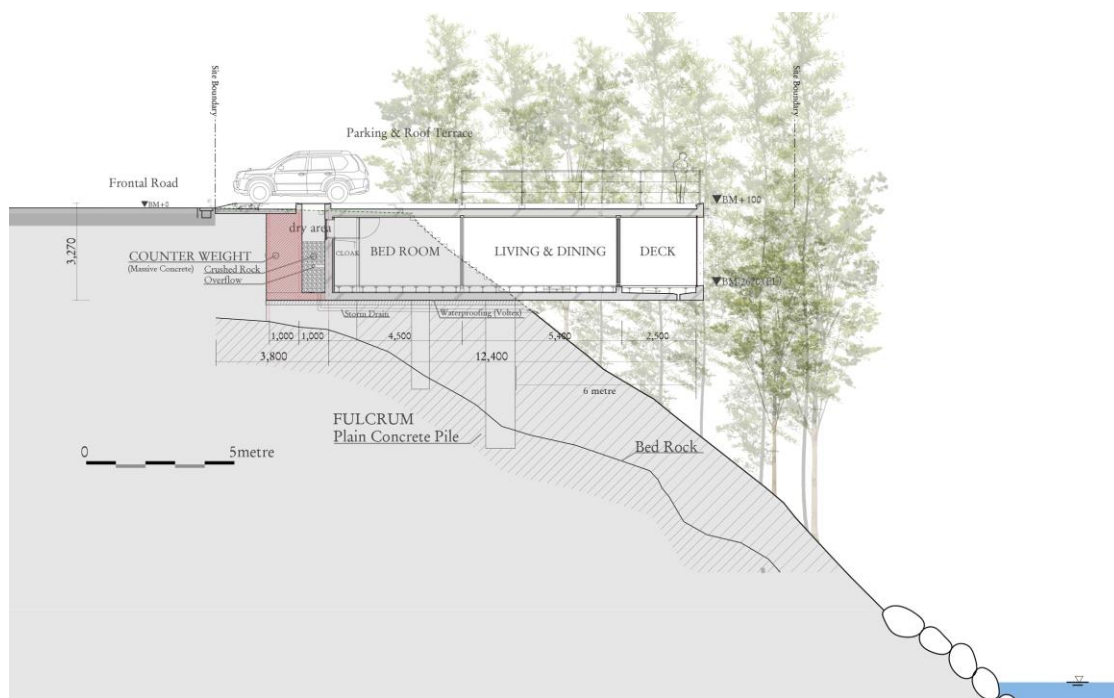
Konceptní diagram objektu Crossed House [13]
